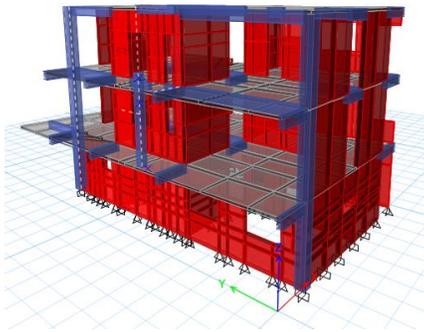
Arquitectura e ingeniería de edificio en Paso Hondo
